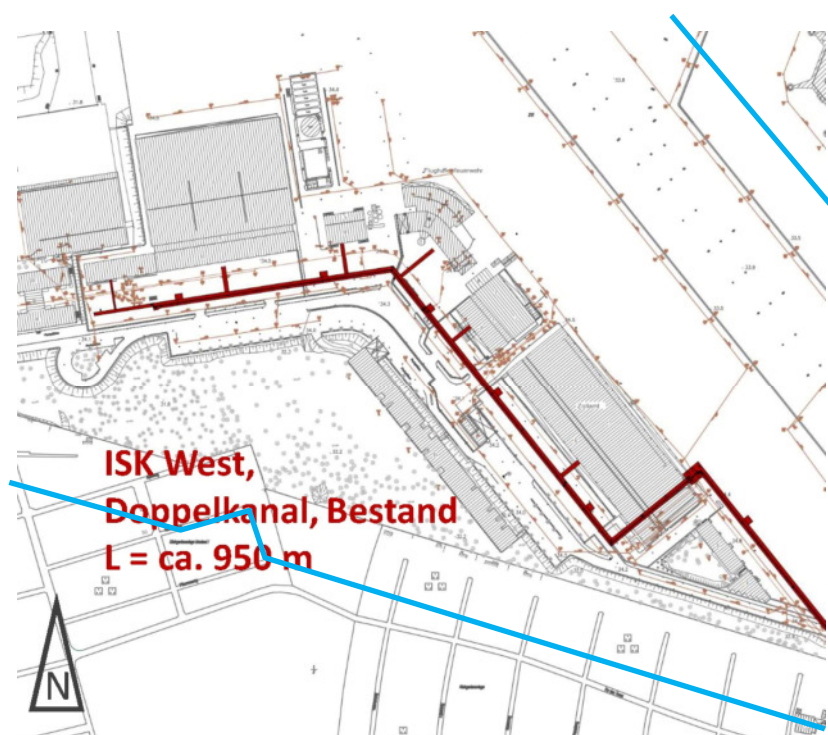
Infrastrukturkanal West mit Abgrenzung des Bebauungsplans 12-50a (blau)
